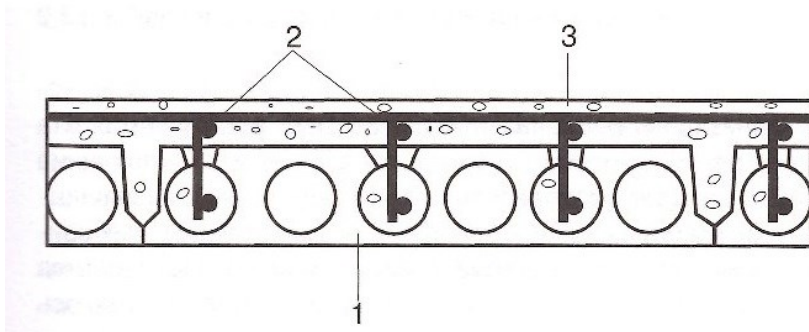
Схема посилення залізобетонної пустотілої плити:
